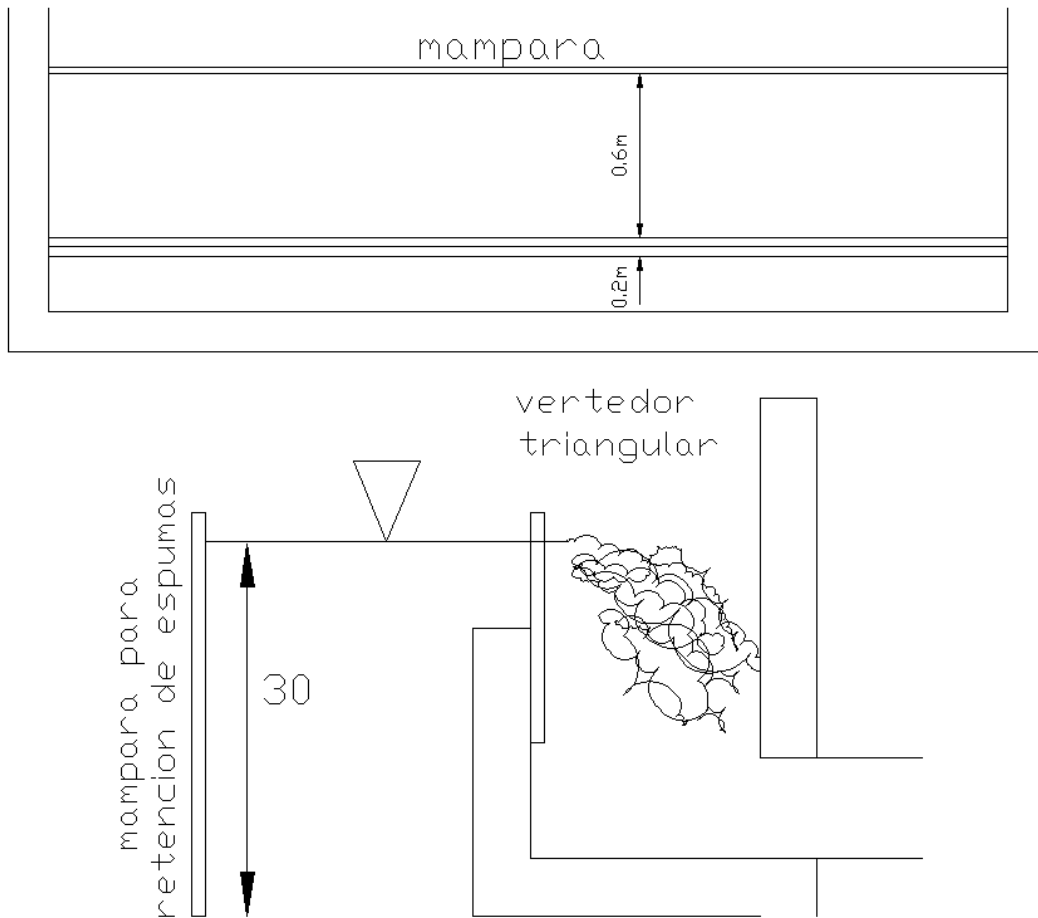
Planta del mecanismo de salida del tanque sedimentador primario
